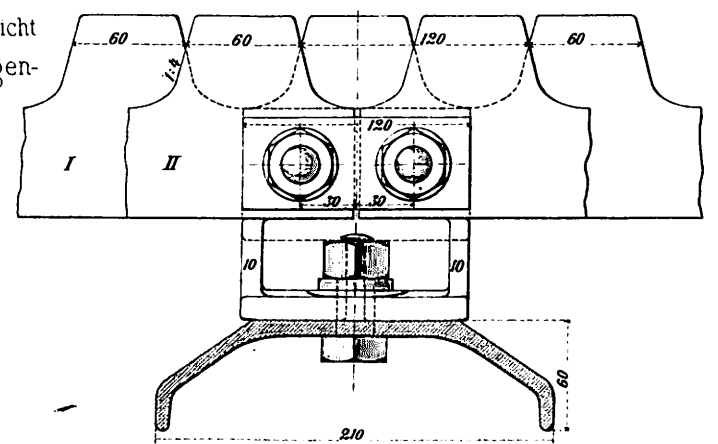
Grundriss des Zahnstangen-Lagers. 1:4.
